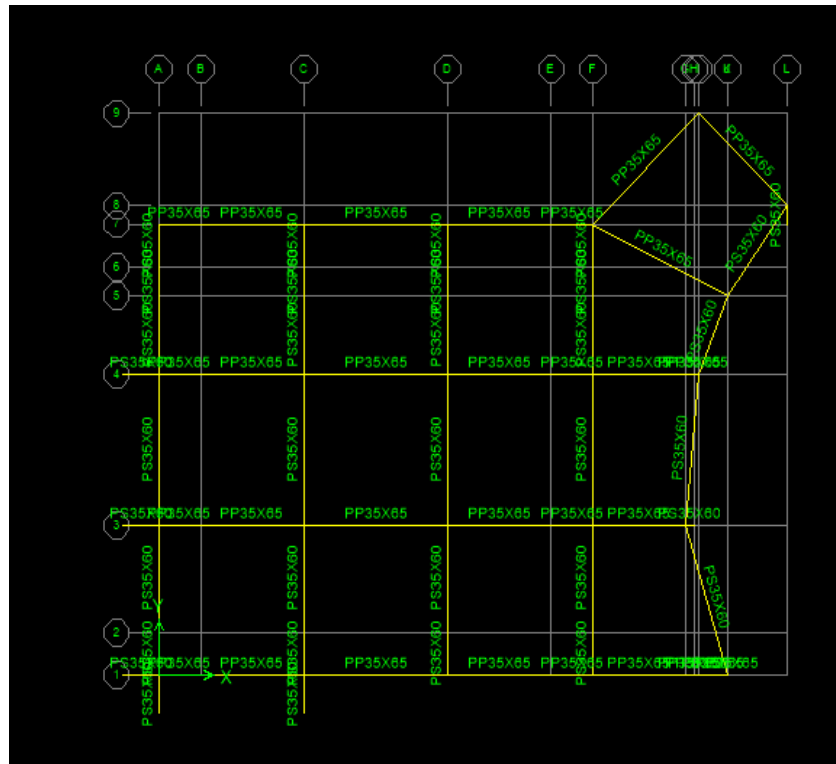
Plan de repérage des poutres et des chainages (B2).
